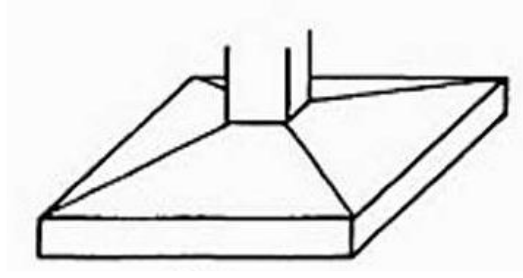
Sapata Isolada – Fonte: ABMS/ABEF (1998).
